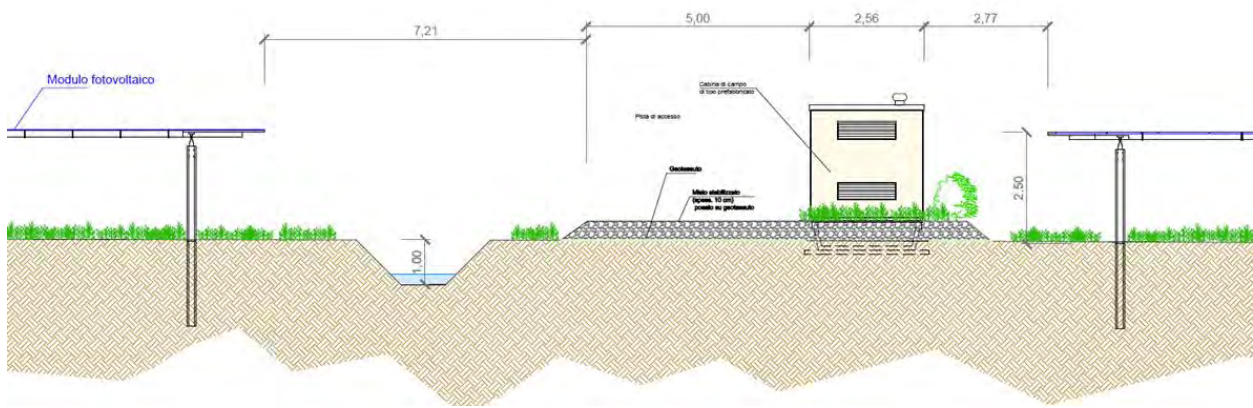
Sezione tipo della pista interna di gestione dell'impianto
